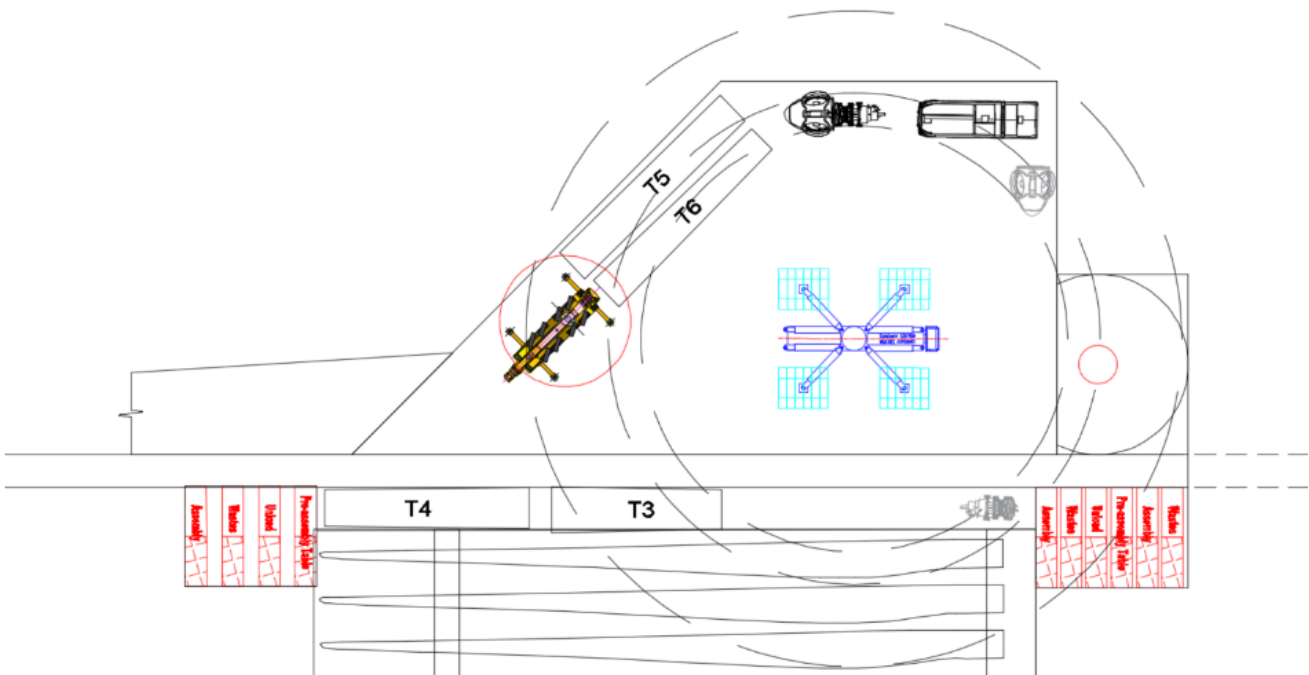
Tipico Piazzola di Cantiere durante la Seconda Fase di Montaggio
